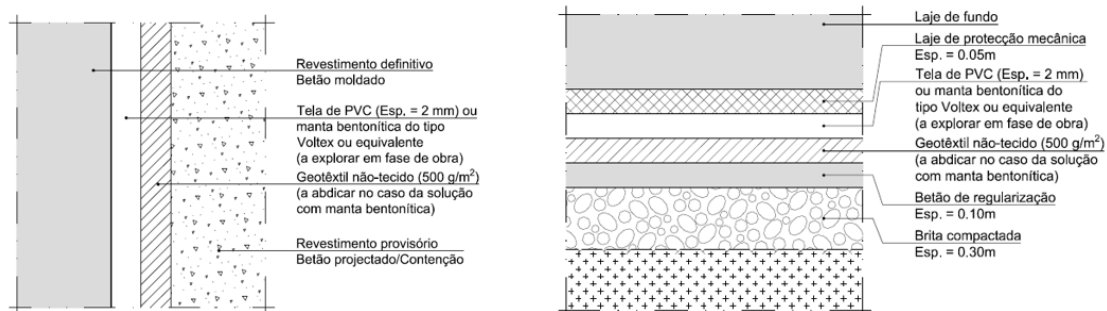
Sistema de impermeabilização do revestimento definitivo das estruturas executadas a céu aberto (poço)
